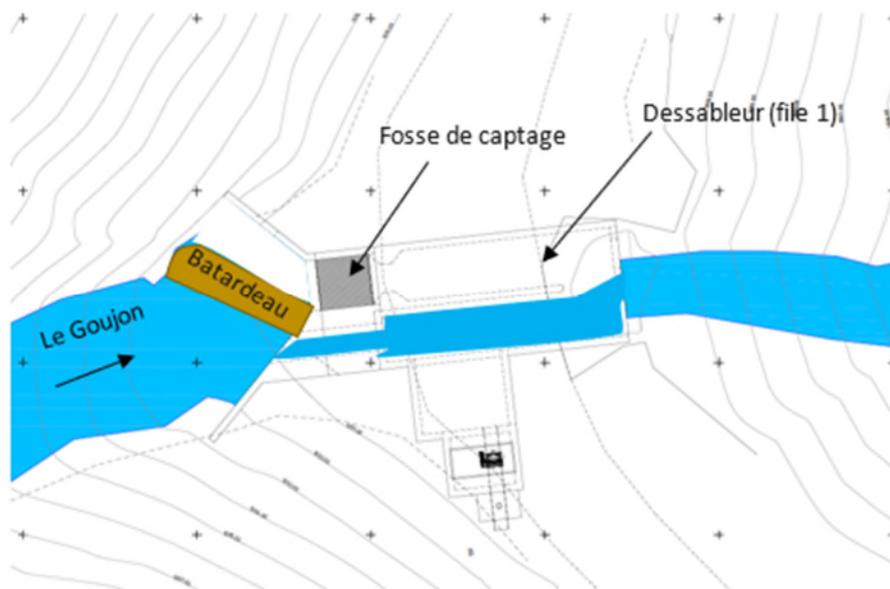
Travaux de construction de la prise d'eau – Phase 2
